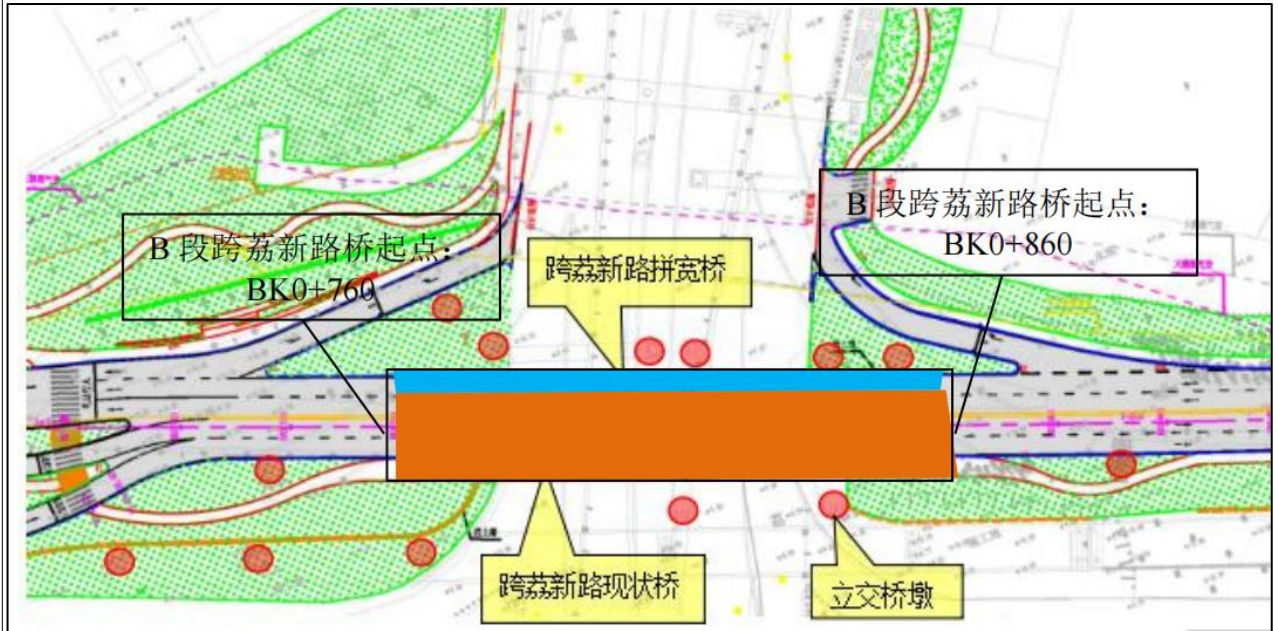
瑶田路 B 段 K0+760~K0+860 平面图
